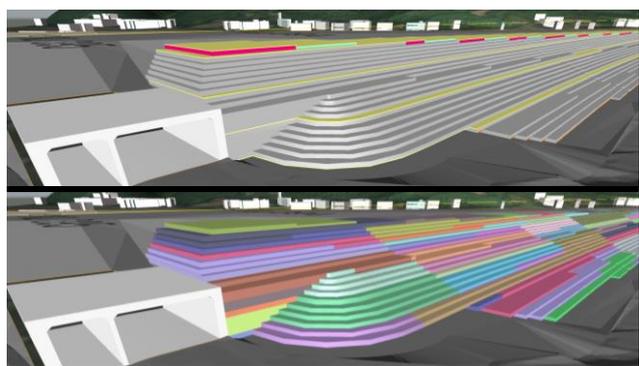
色による施工情報の可視化(上:材料, 下:施工日)
